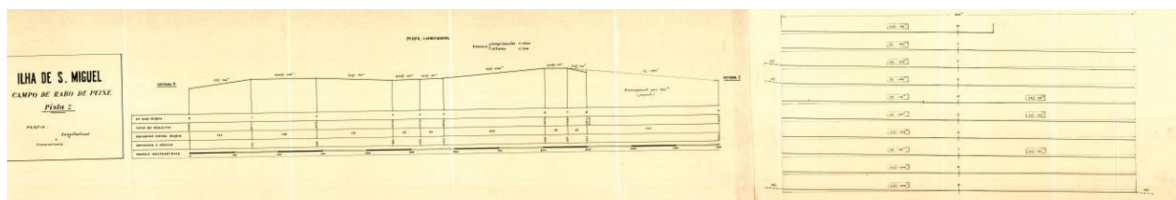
Projeto de prolongamento da pista 4 perfil longitudinal e perfis transversais
